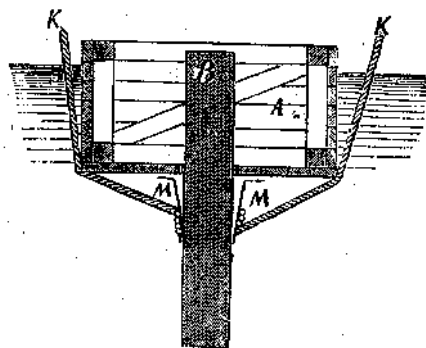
Приспособленіе для нарубанія шпиль на сваяхъ: А—ящикъ; В—свая; М, м—кожаный рукавъ; к, к—веревка.
